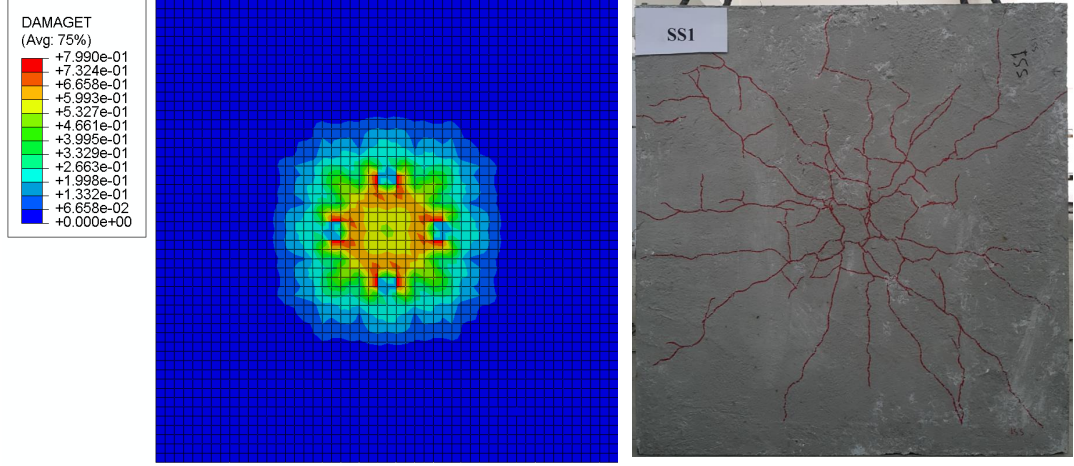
(Devam) SH4 betonarme plağına ait nümerik ve deneysel sonuçların karşılaştırması
